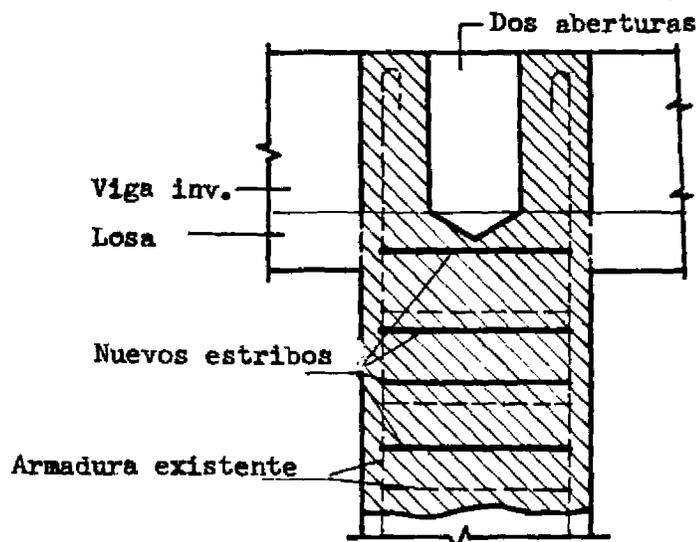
Caso P-4. REHORMIGONADO TRADICIONAL DE UN PILAR Y REFUERZO DE ESTRIBOS
